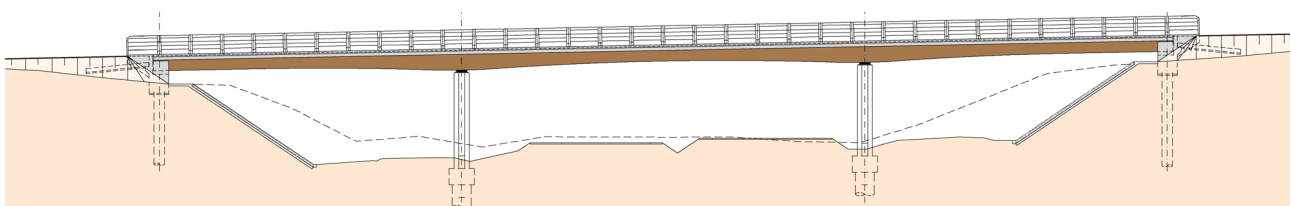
Alzado tipo de las estructuras E-10, E-11 y E-12
